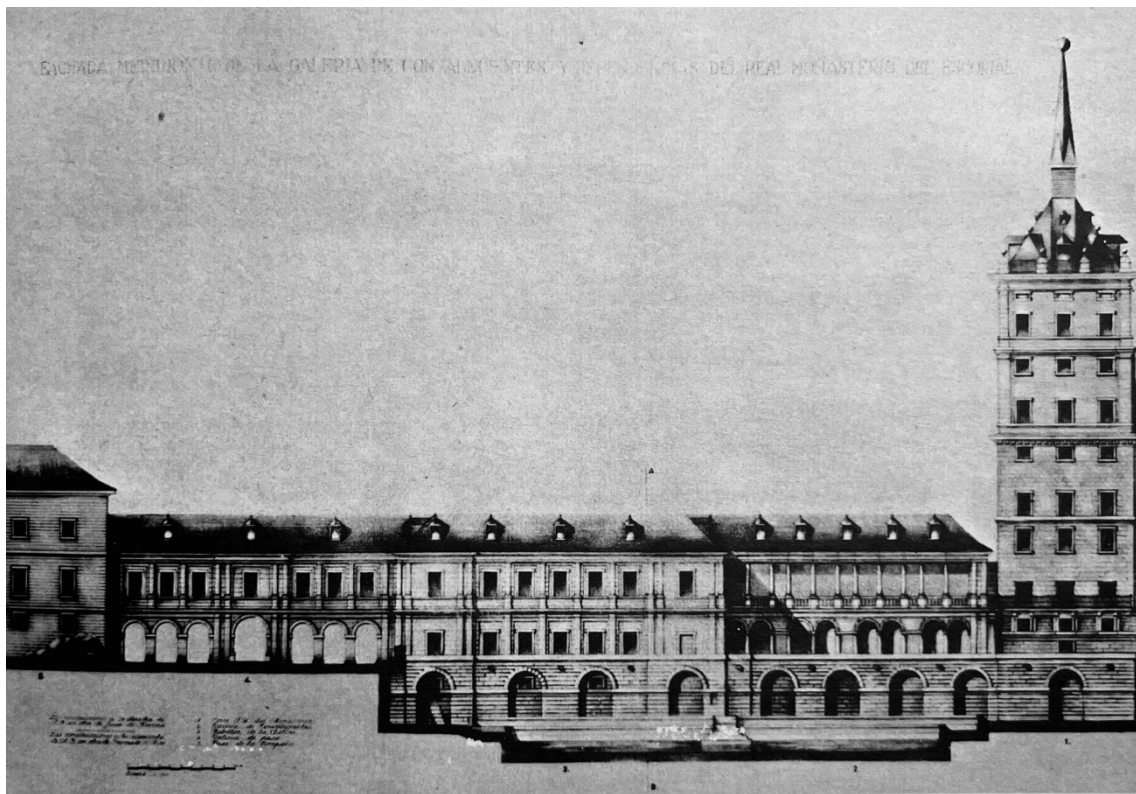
Paso entre la enfermería y la Compañía. Dibujo de 1785 con el alzado sur.
